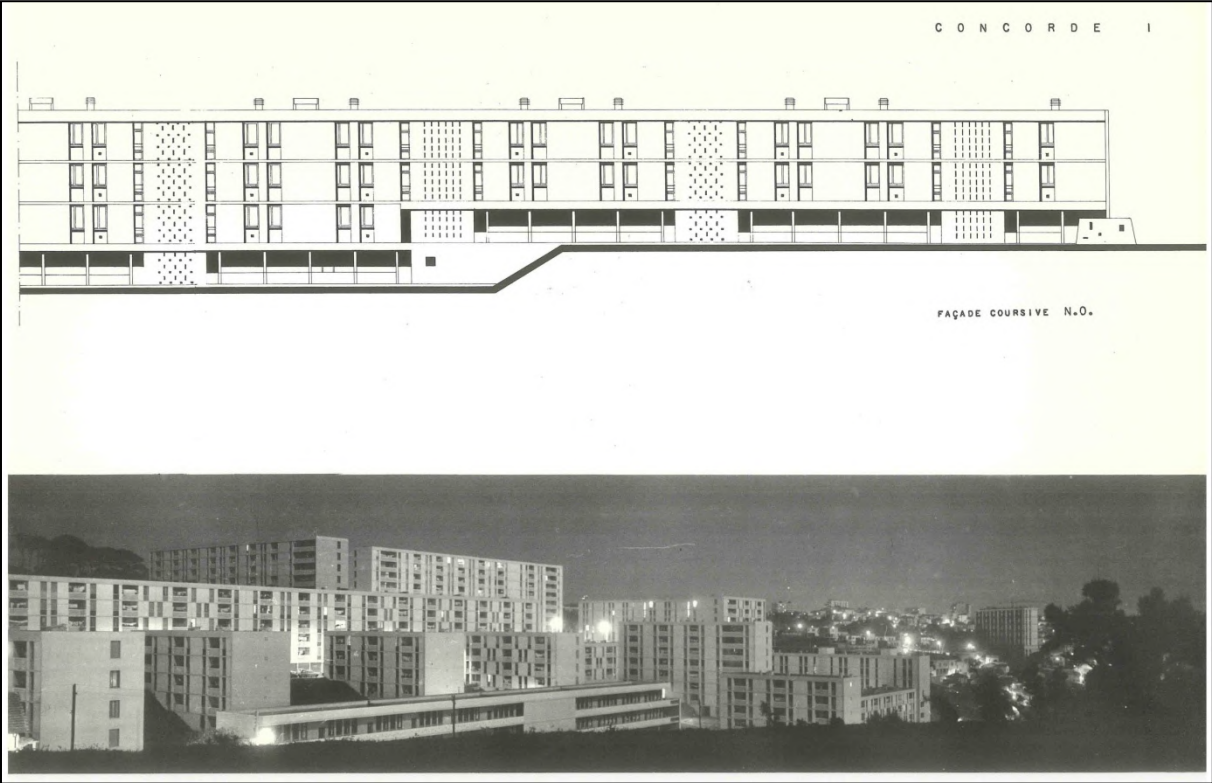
Cité La Concorde I. Façades. De l'auteur.
